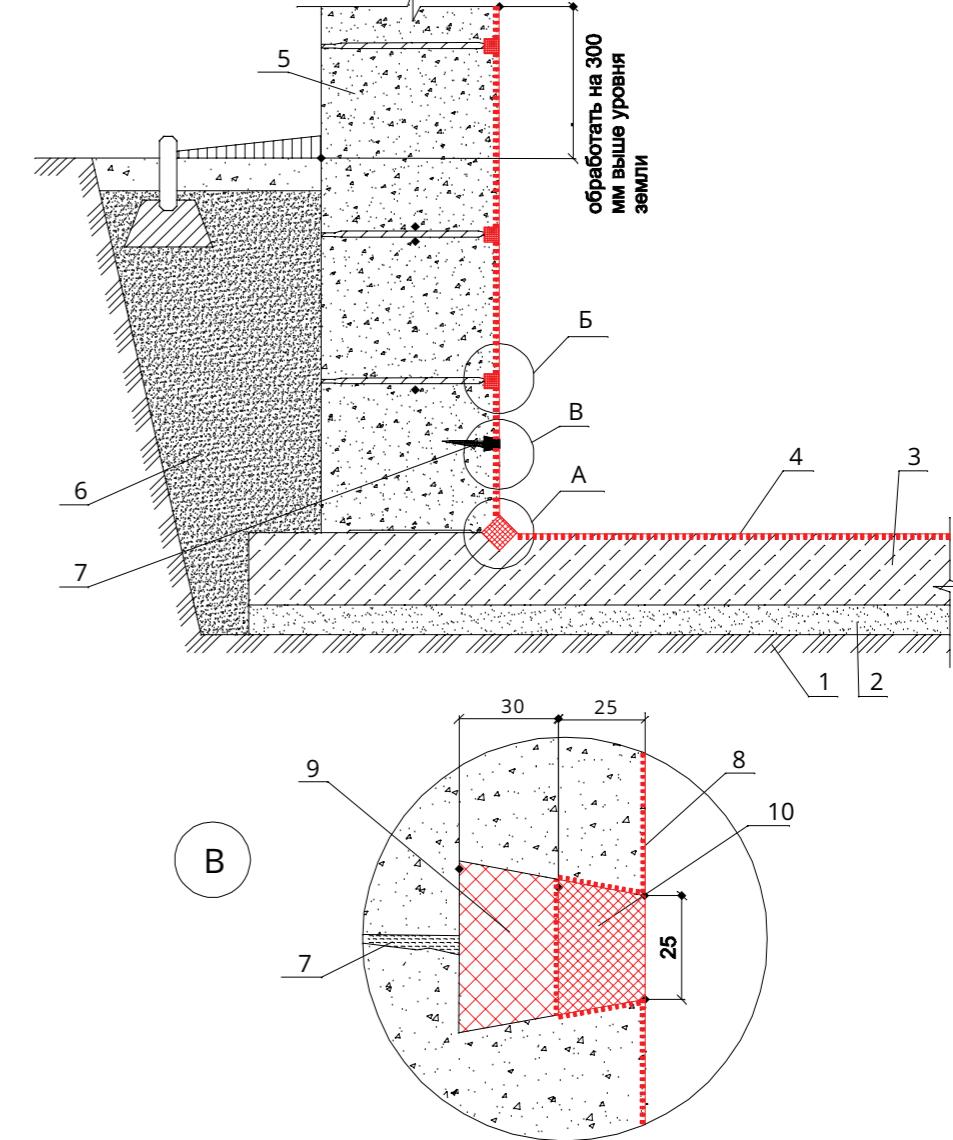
Узел 3. Гидроизоляция сопряжения стены из бетонных блоков и фундаментной плиты; Узел В
